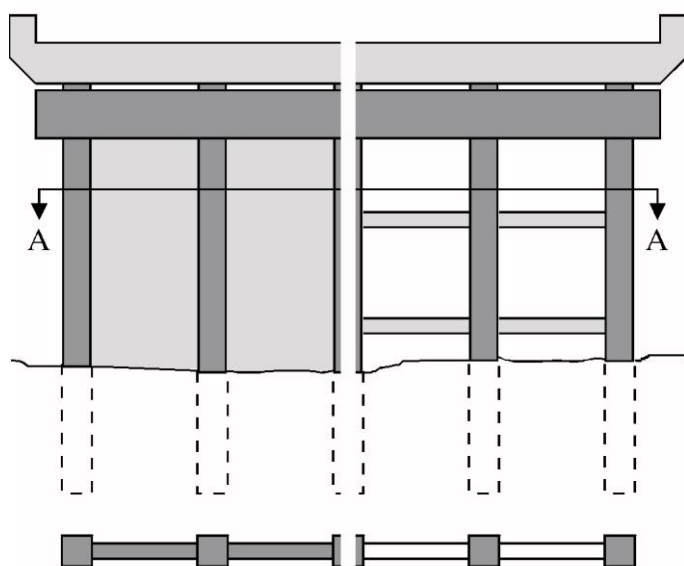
Tipo pilas con pilotes con cabezal y diafragma (o vigas horizontales)
